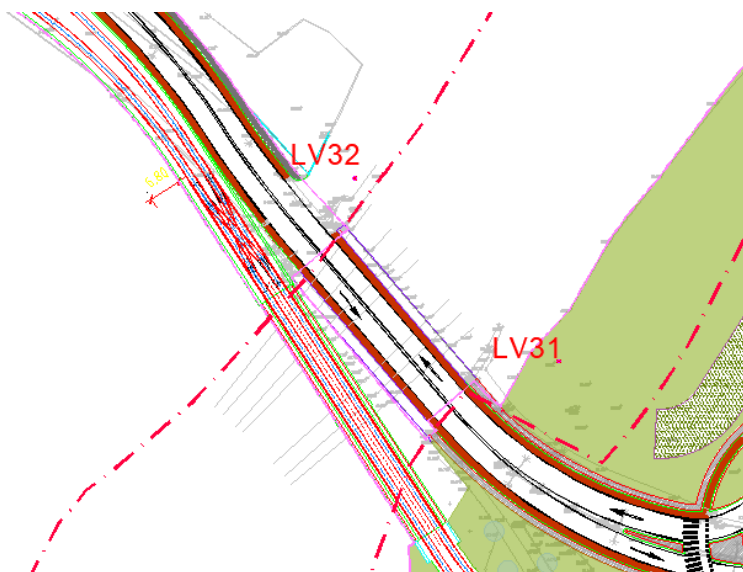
planimetria con il posizionamento dei carotaggi LV31-LV32.
